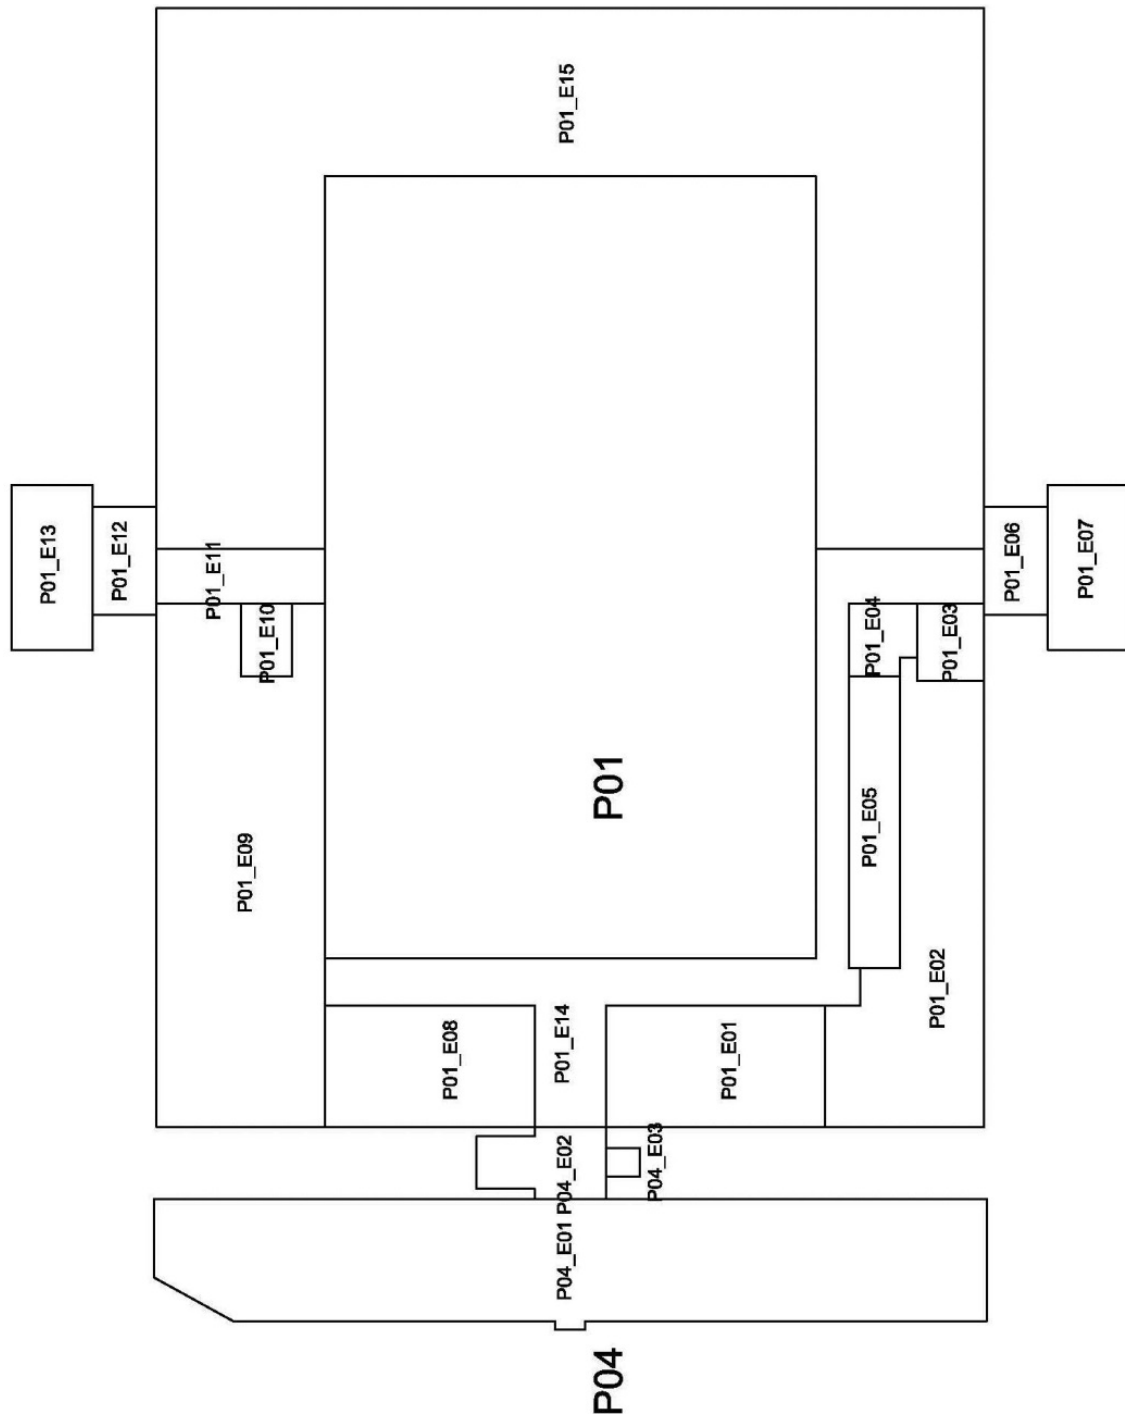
Distribución en planta de los espacios de las plantas P01 y P04.
